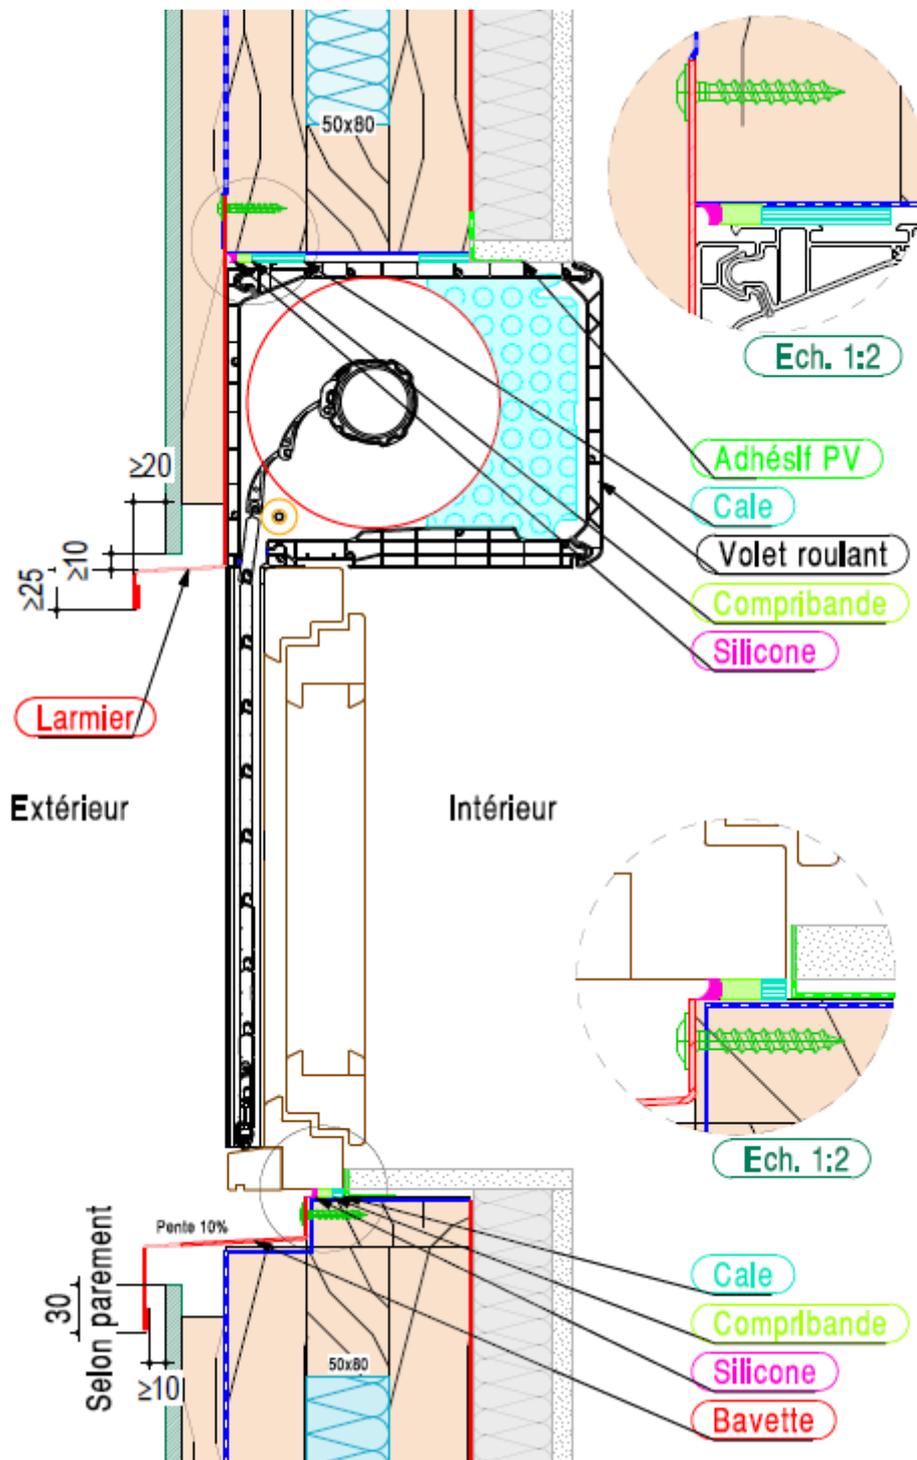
Menuiserie avec volet roulant en tunnel / Coupe verticale
